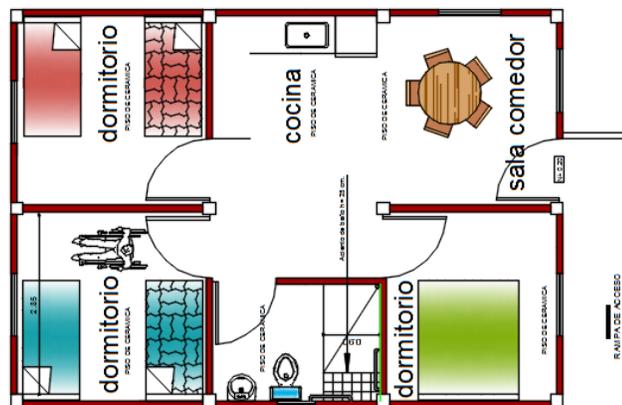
Planta arquitectónica vivienda tipo proyecto "Nulti".
